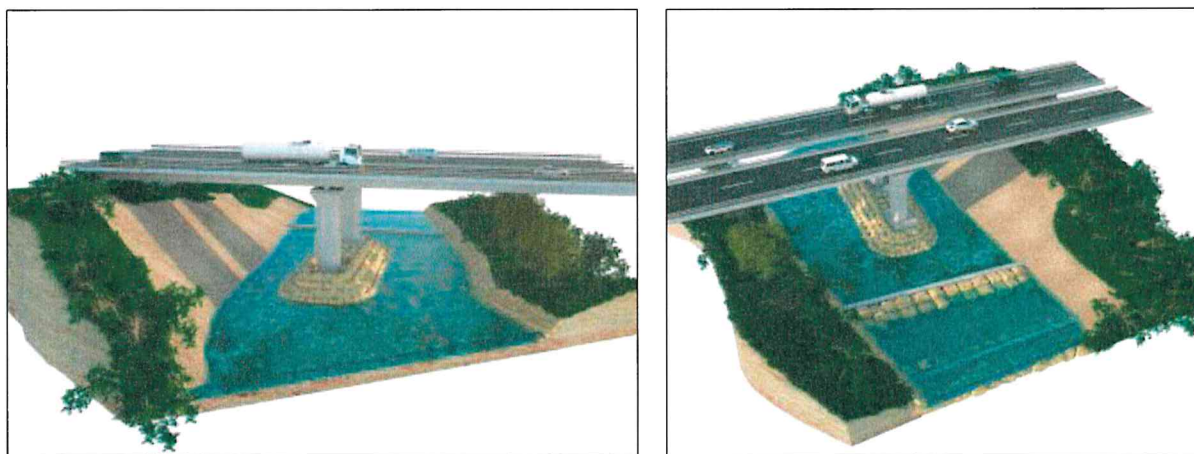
Rendering sistemazione finale (da Elab. C_01_Documentazione fotografica allegata allo SPA)
